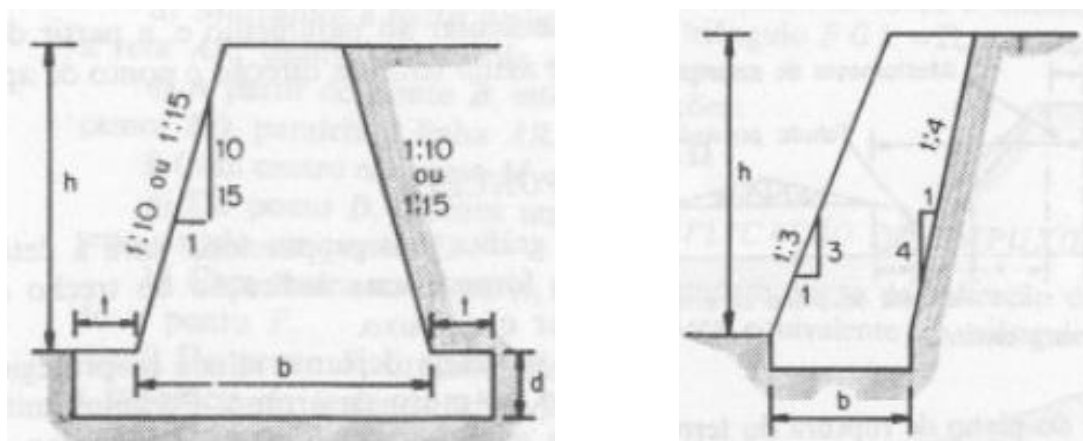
Muros de concreto ciclópico com perfis trapezoidais
